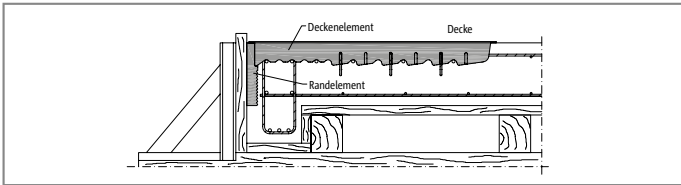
IDock2: Randunterzug als Auflager; die Deckenaussparung wird durch die beiden Komponenten Randelement und Deckenelement abgeschalt.
